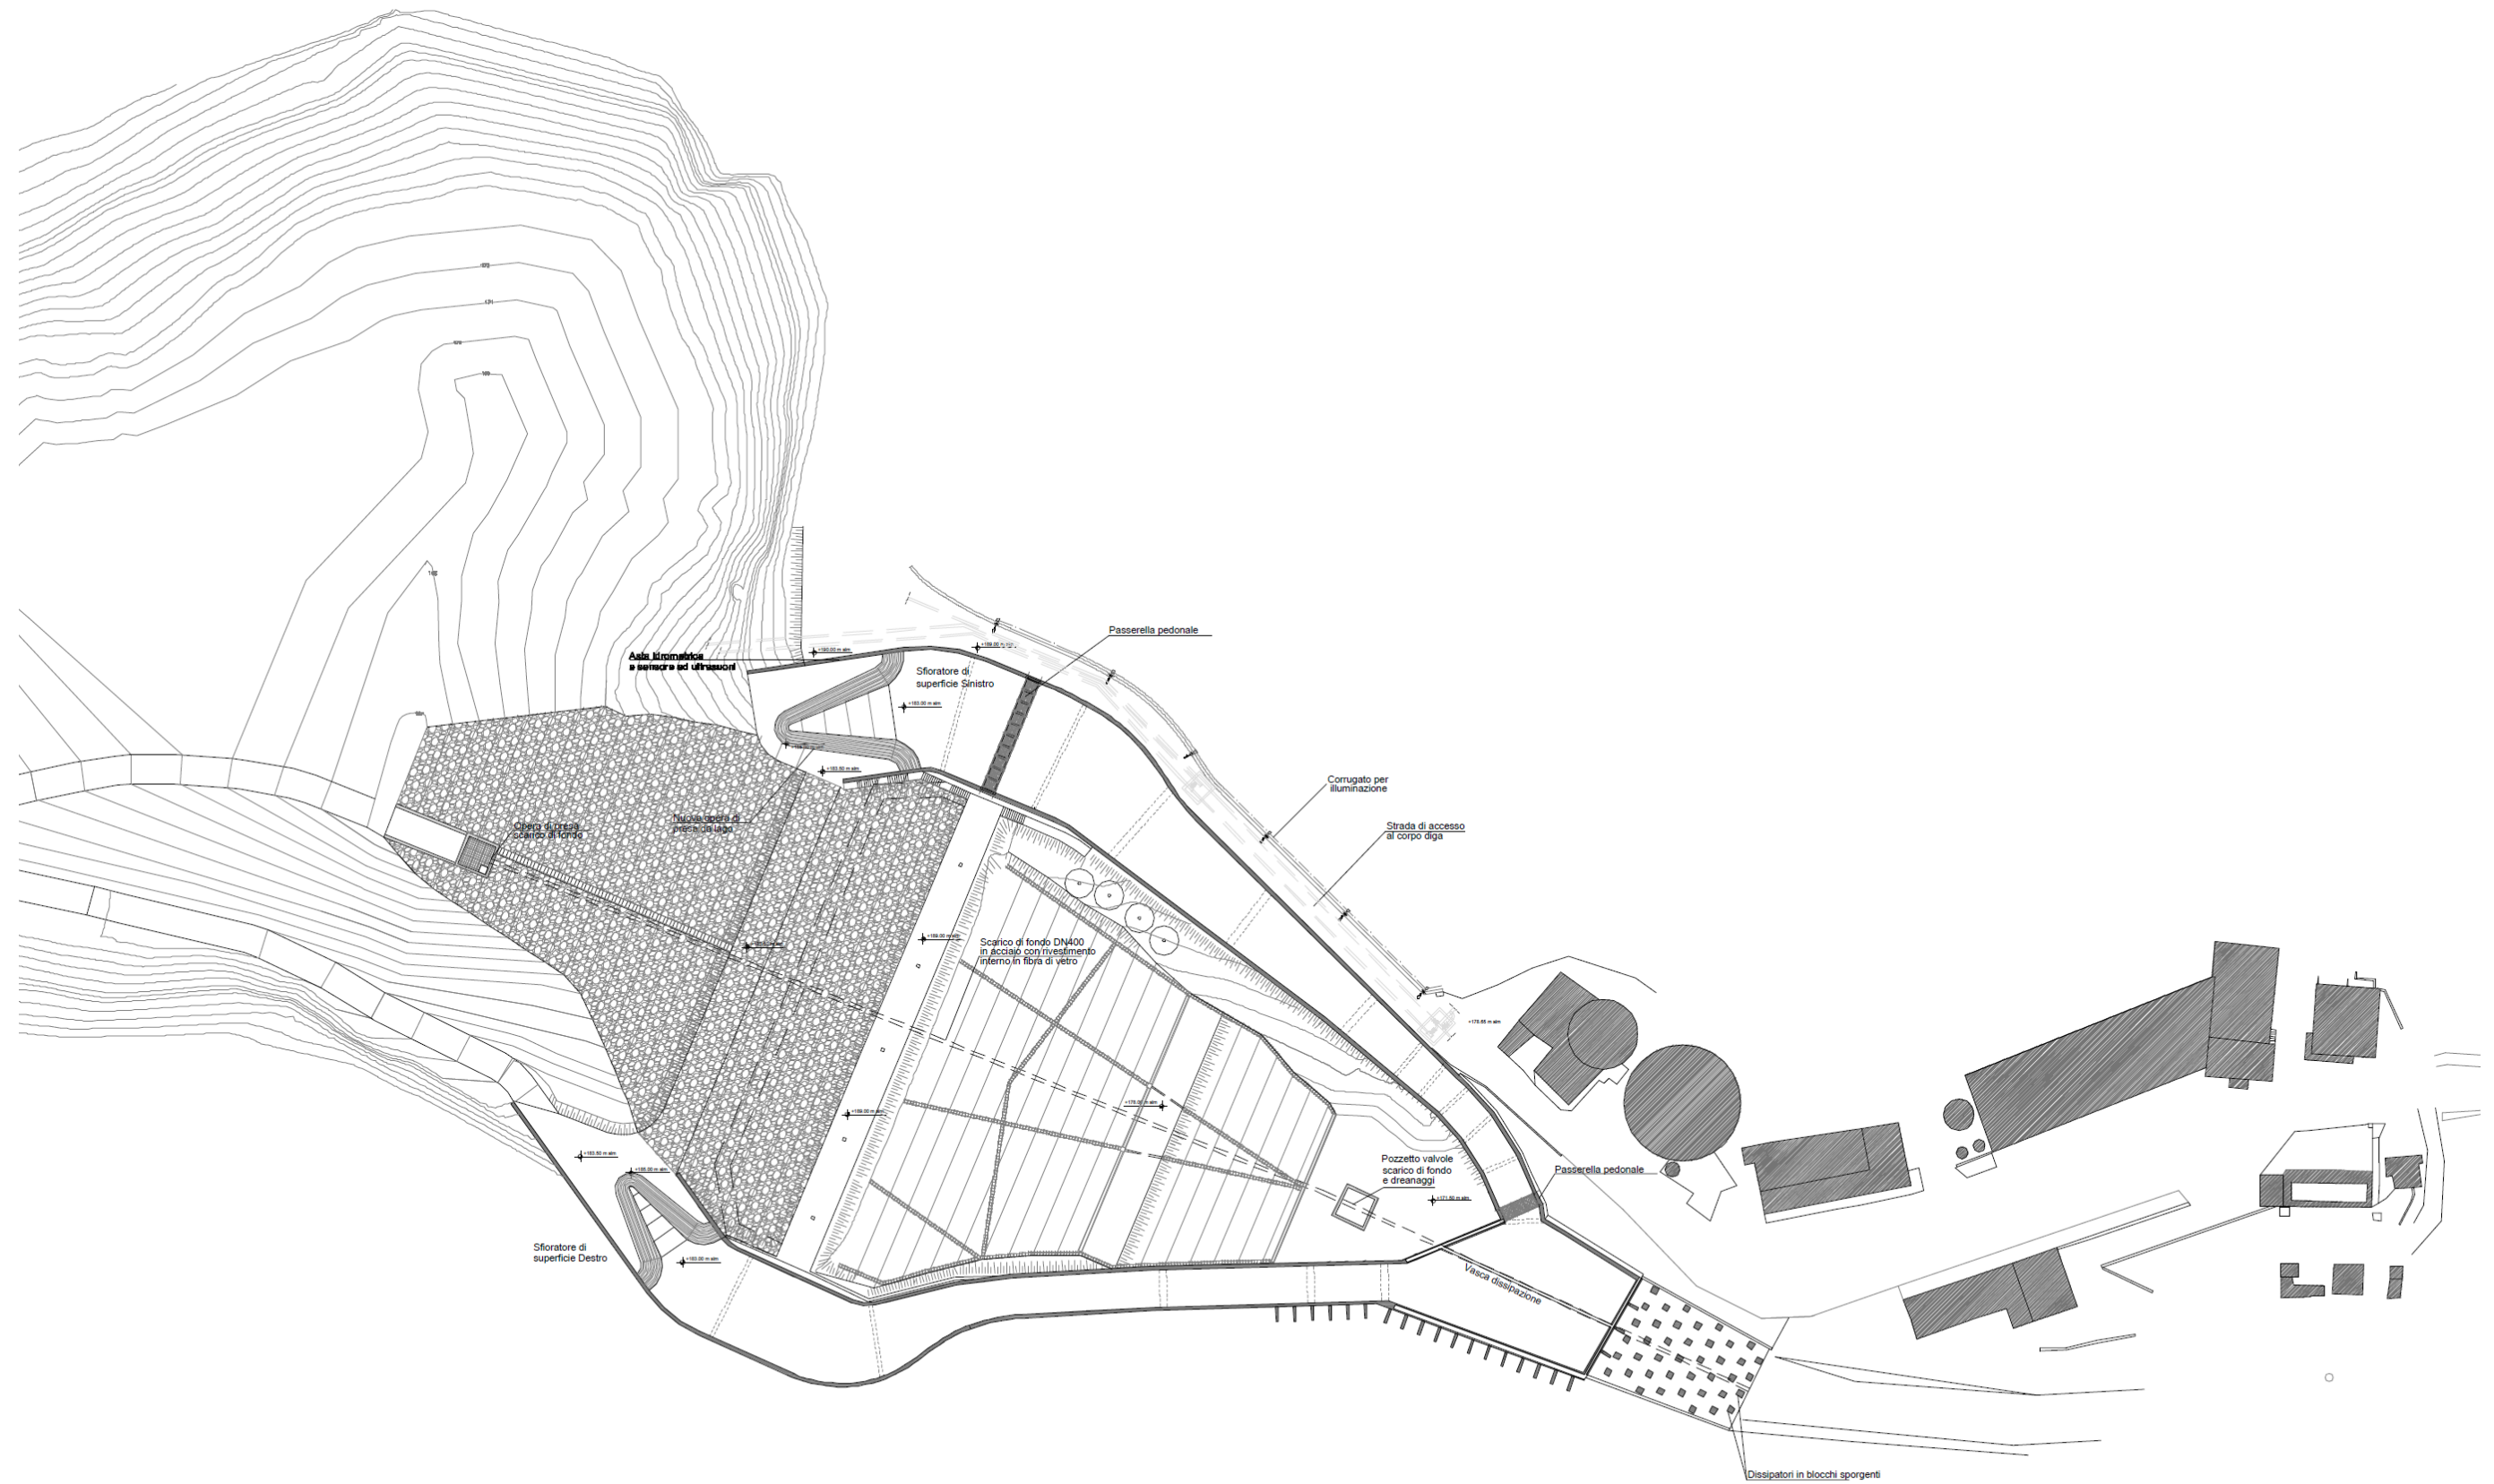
Planimetria della diga Drove di Cepparello nello stato di progetto.
